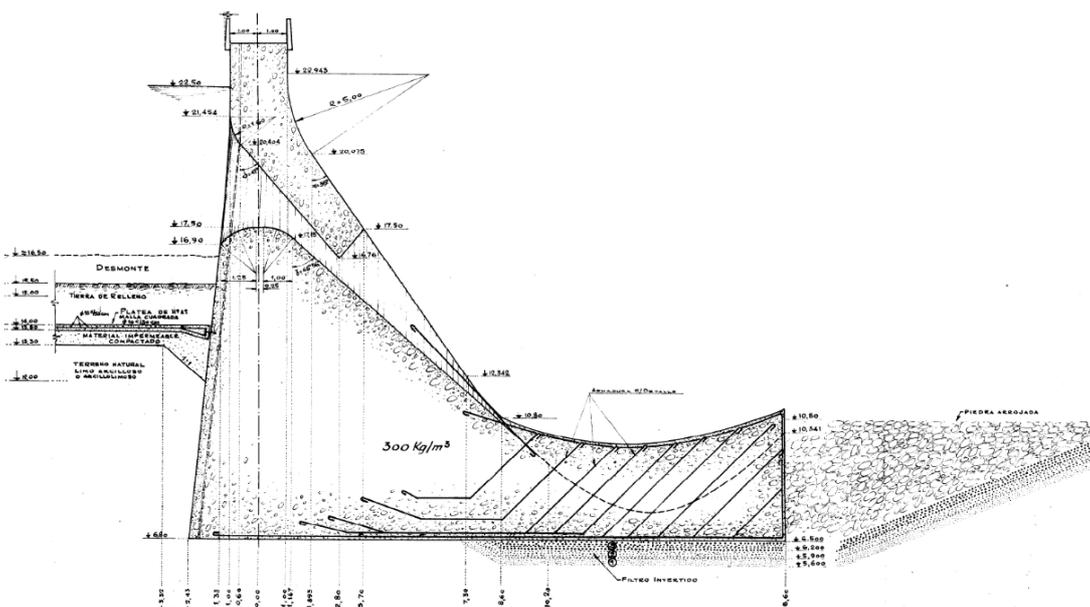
Perfil Tipo Orificio Regulador Presa de Hormigón
